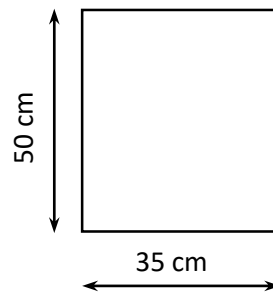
Pré-dimensionnement de la poutre palière (les escaliers de 3 volée)
